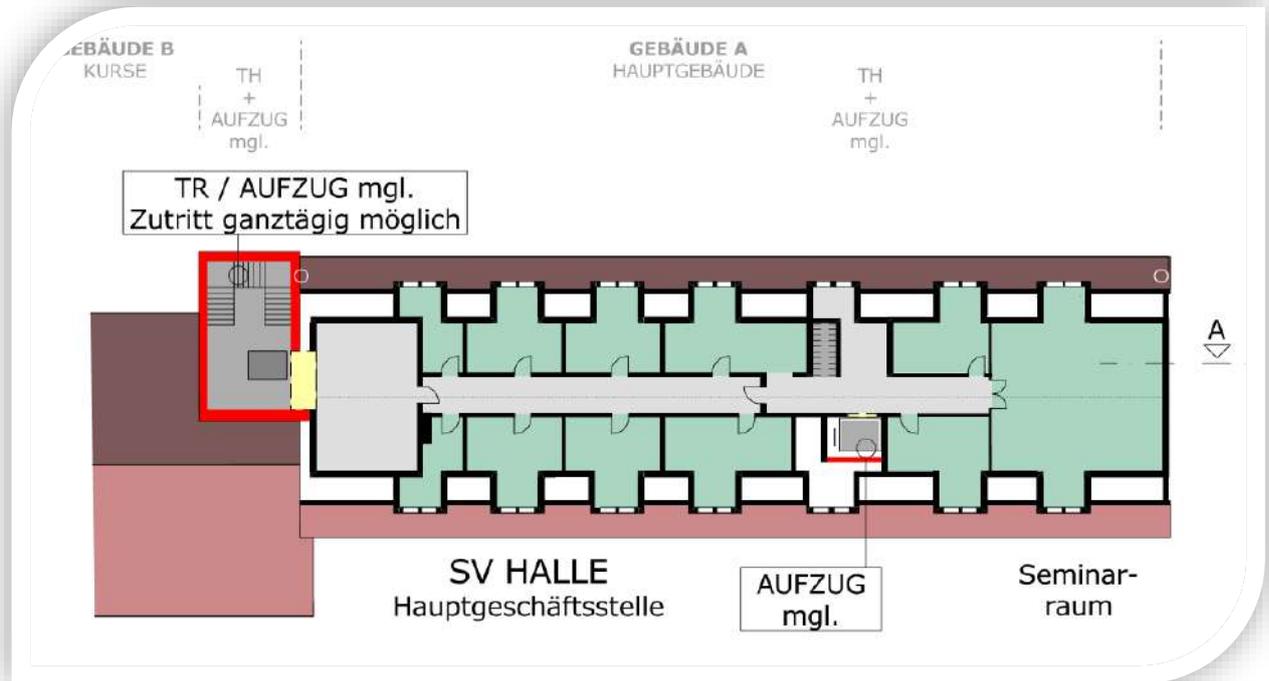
Zweites Obergeschoss (Seminarraum, Hauptgeschäftsstelle des SV Halle)
